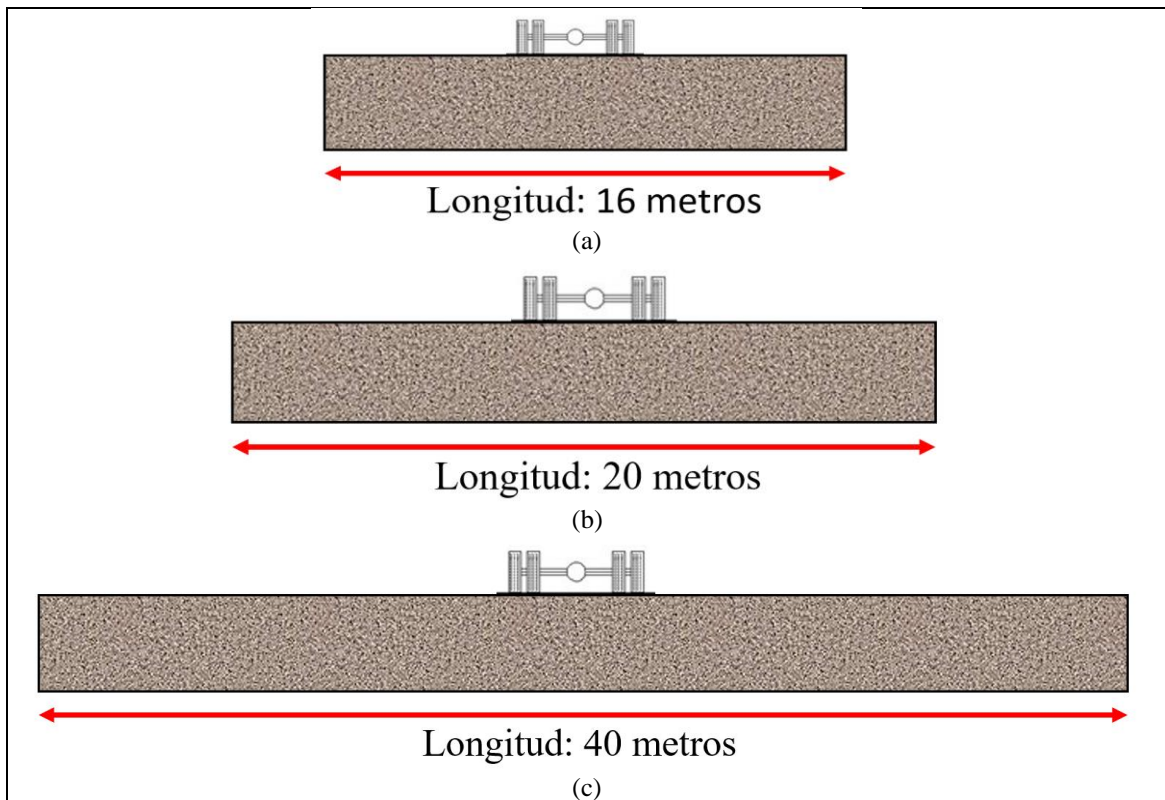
Longitudes de estructura de pavimento. (a) 16 [m] (b) 20 [m] (c) 40 [m]. Fuente: Elaboración propia.
